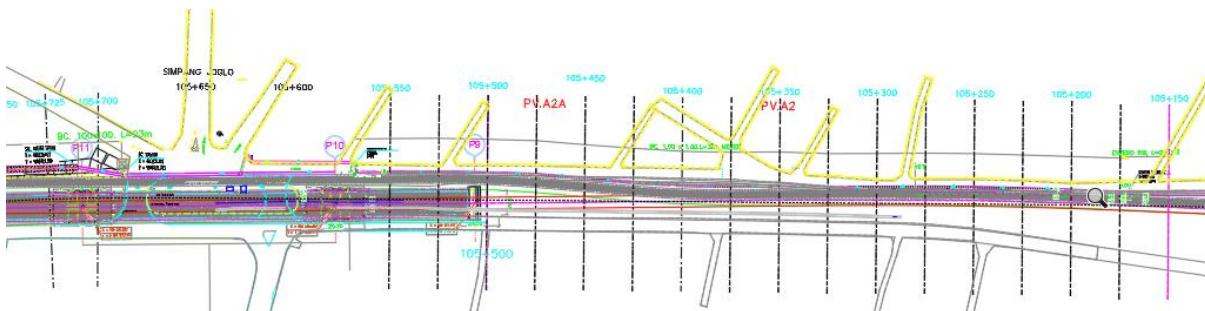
20 Layout Rencana Saluran U-Ditch 140.140
